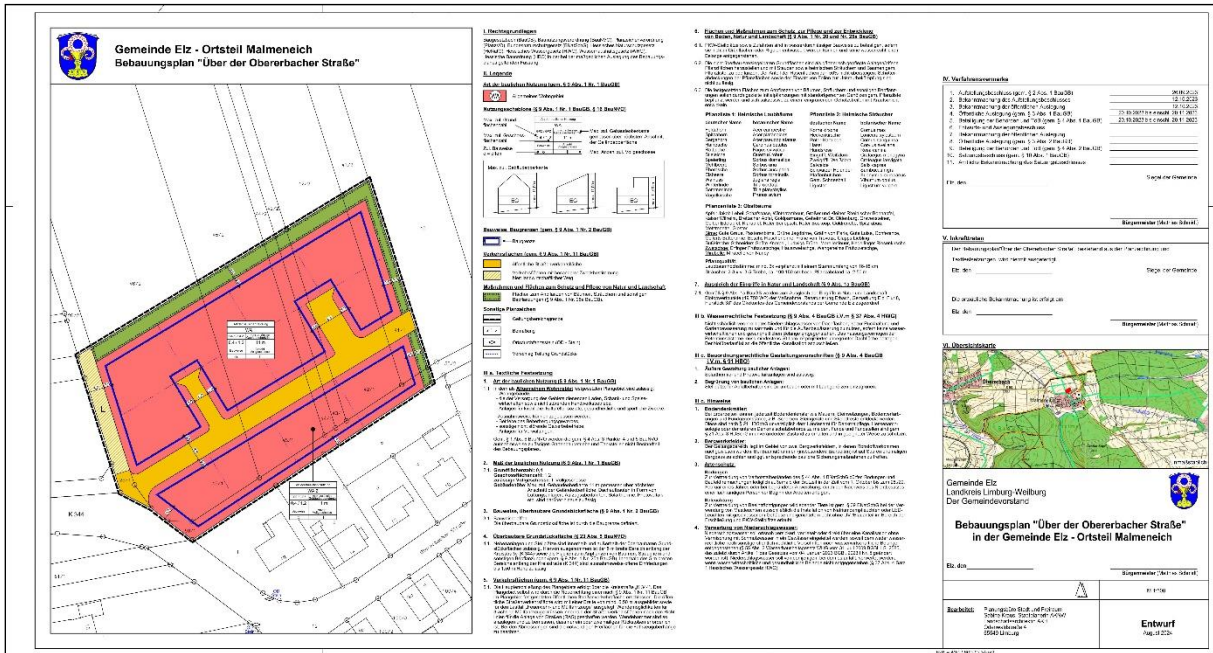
Bebauungsplan „Über der Obererbacher Straße“ Gemeinde Elz, Ortsteil Malmeneich, Kraus 2024
